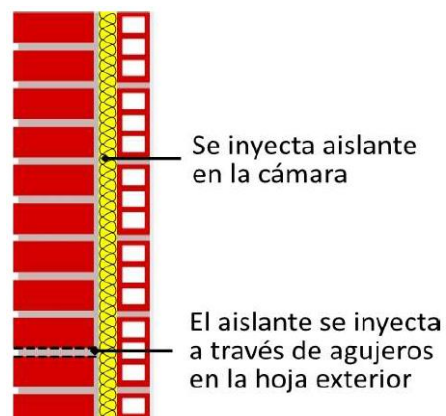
Aislamiento de fachada. Relleno de cámara.
